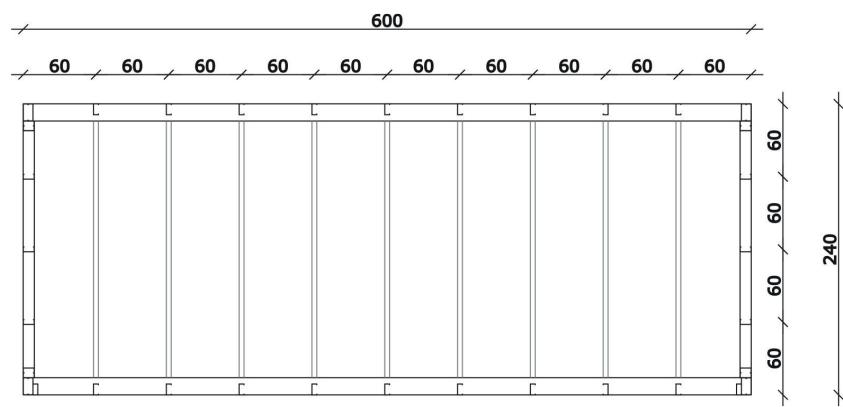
Planta baixa esquemática do módulo (em centímetros)
